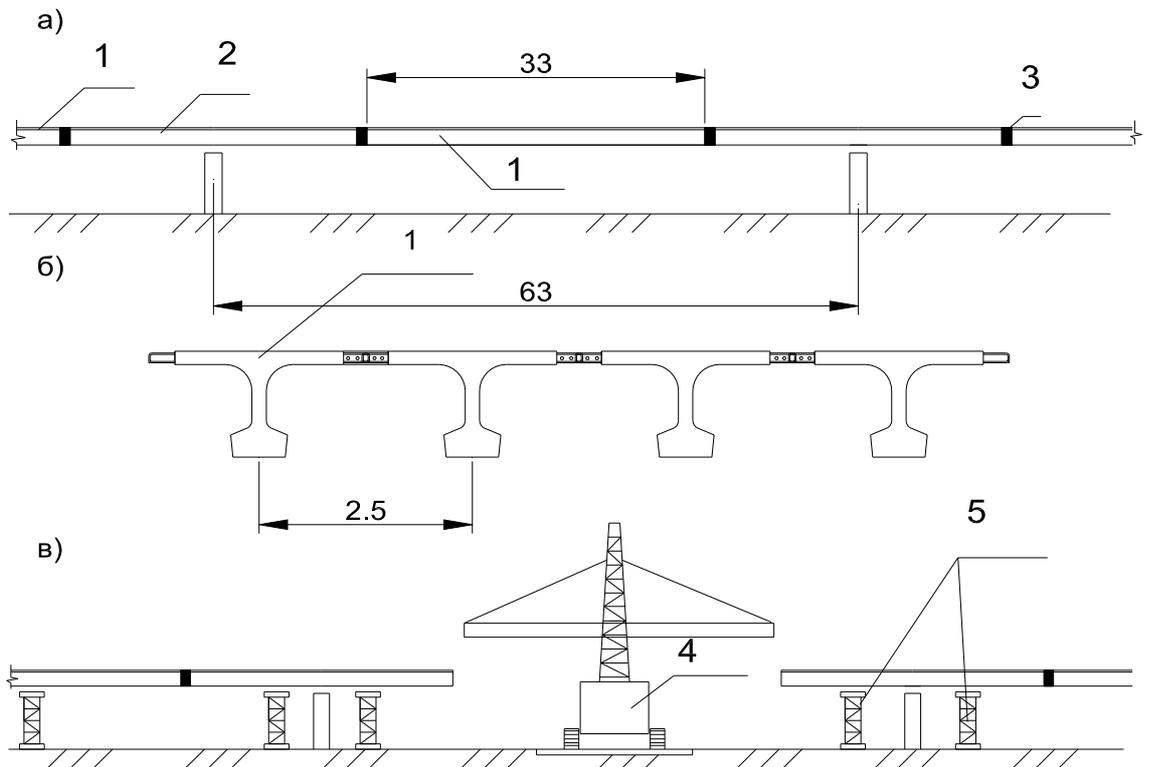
Монтаж сборных неразрезных пролетных строений из длиномерных элементов: 1-предварительно напряженный блок; 2-надпорный блок с ненапрягаемой арматурой; 3-монолитный стык; 4-стреловой самоходный полноповоротный кран; 5-временные опоры
